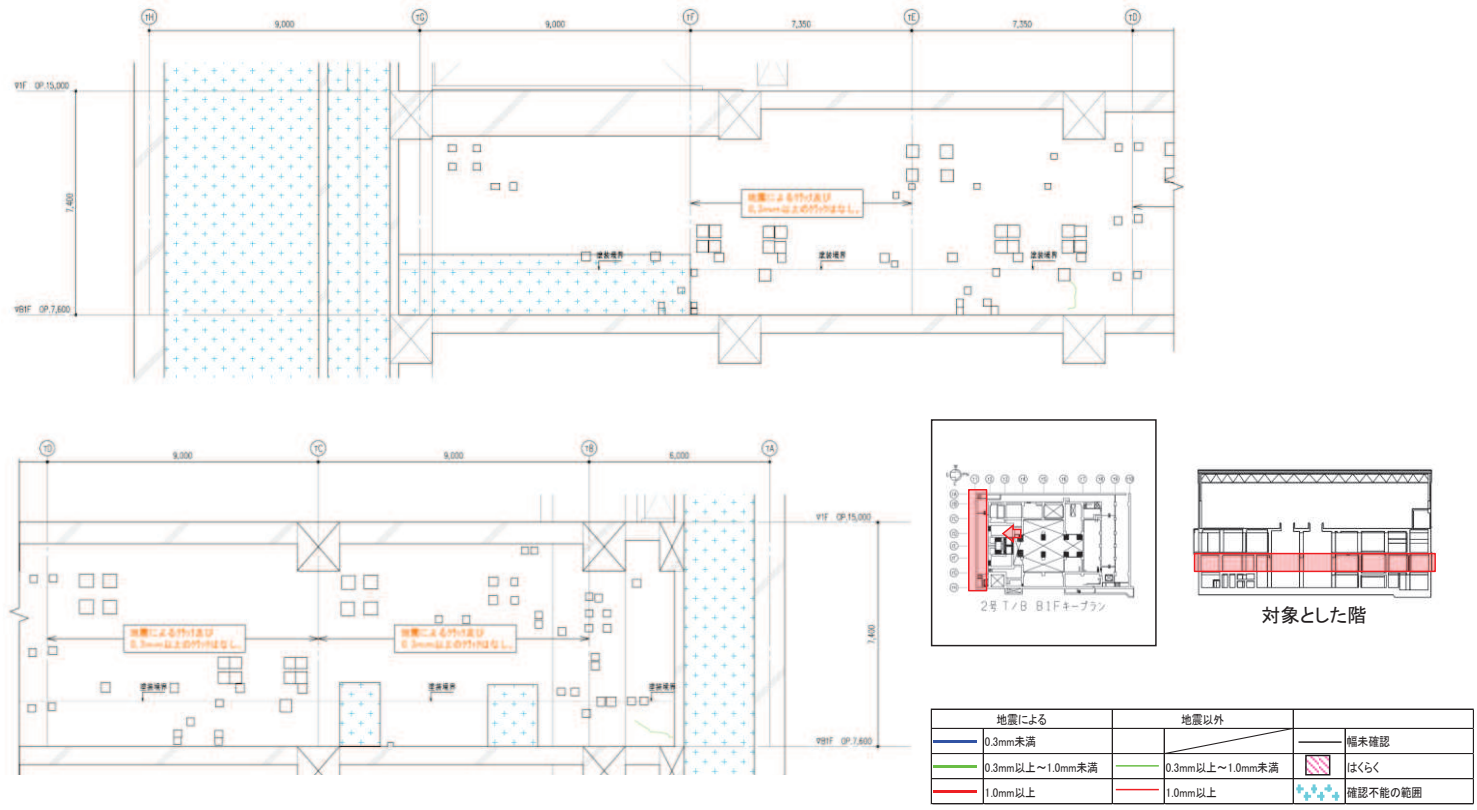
タービン建屋のひび割れ分布 耐震壁 (17) 地下 1 階 T1 通り
